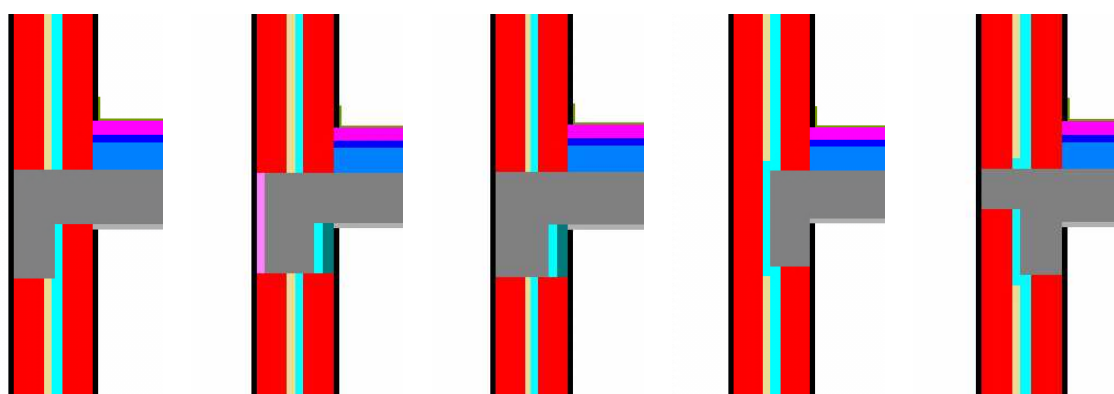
Pormenores esquemáticos de soluções de parede dupla visando a correcção de pontes térmicas planas (Adaptado de Santos, 2007)
